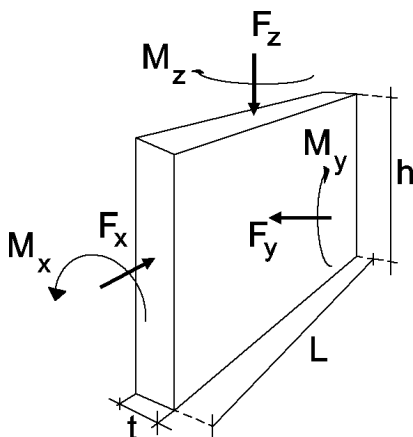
Pannello murario e schema delle azioni secondo i tre assi di riferimento
